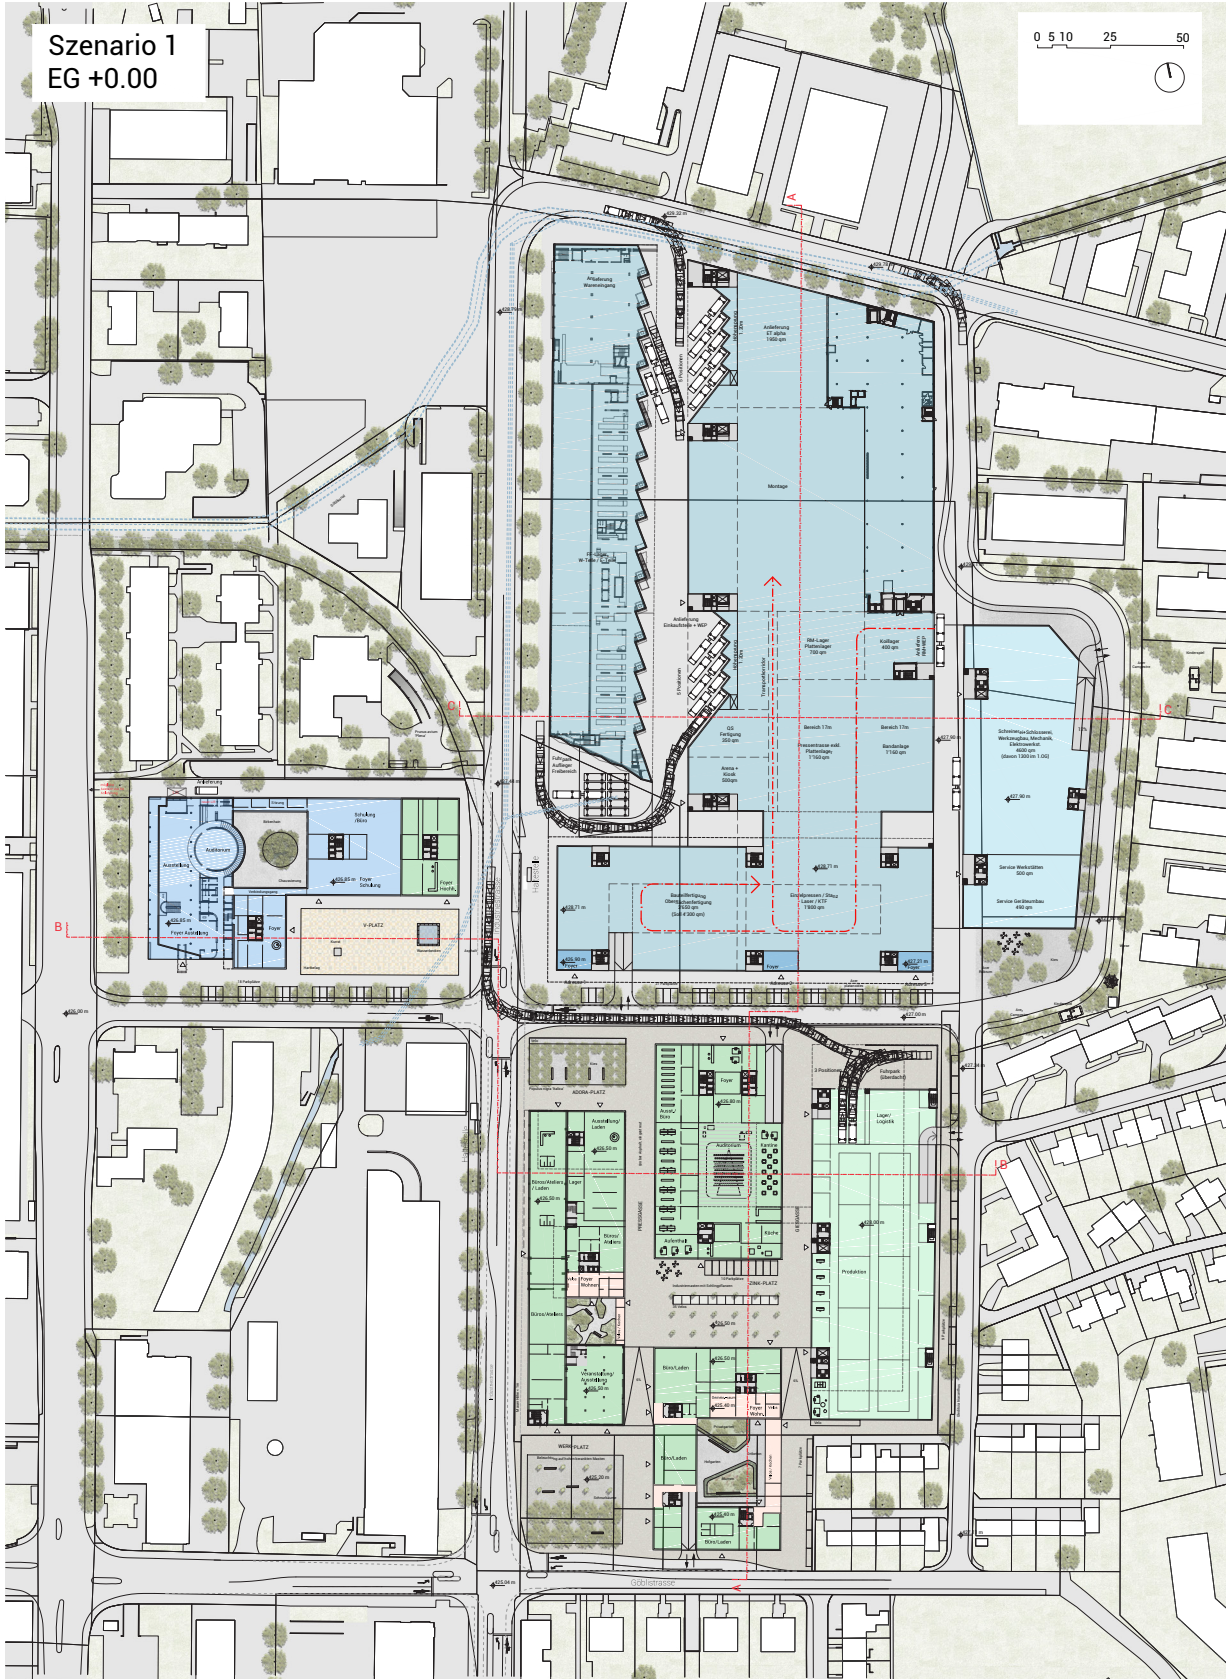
Grundriss EG Szenario 1
